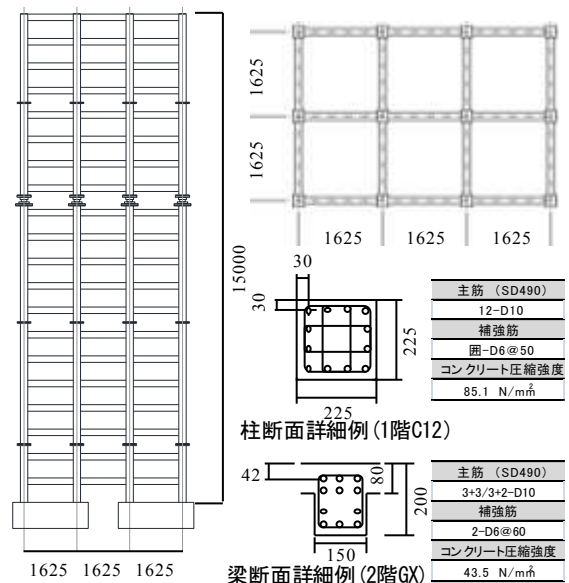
試験体図, 柱・梁断面図 (単位: mm) ²)
